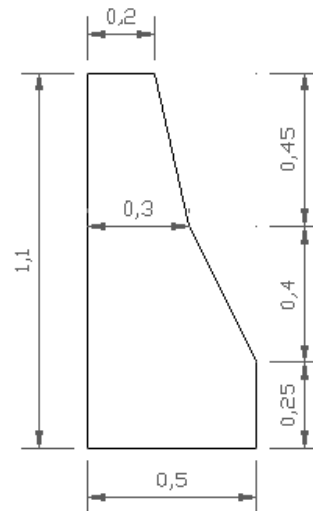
Sección transversal adoptada para protección lateral vehicular parapeto (PV-5)
